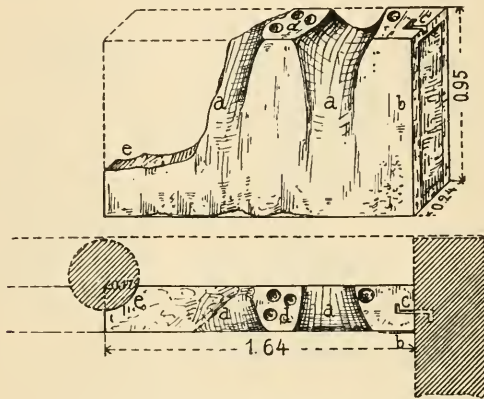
Grundriss und Aufriss eines Steines des Schöpfbrunnens der Enneakrunos.
